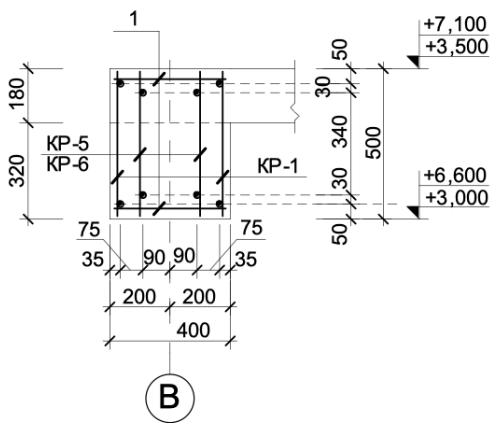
Армування балок перекриття і покриття (розріз 2-2)
